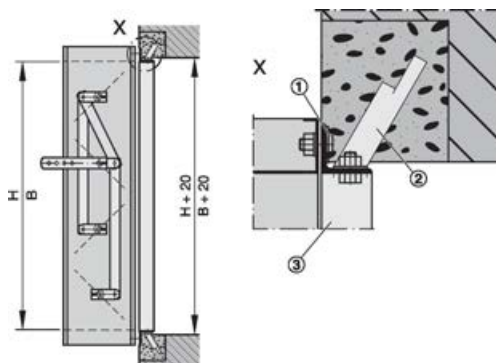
Installation murale avec contre-cadre (construction en acier/acier inox)
